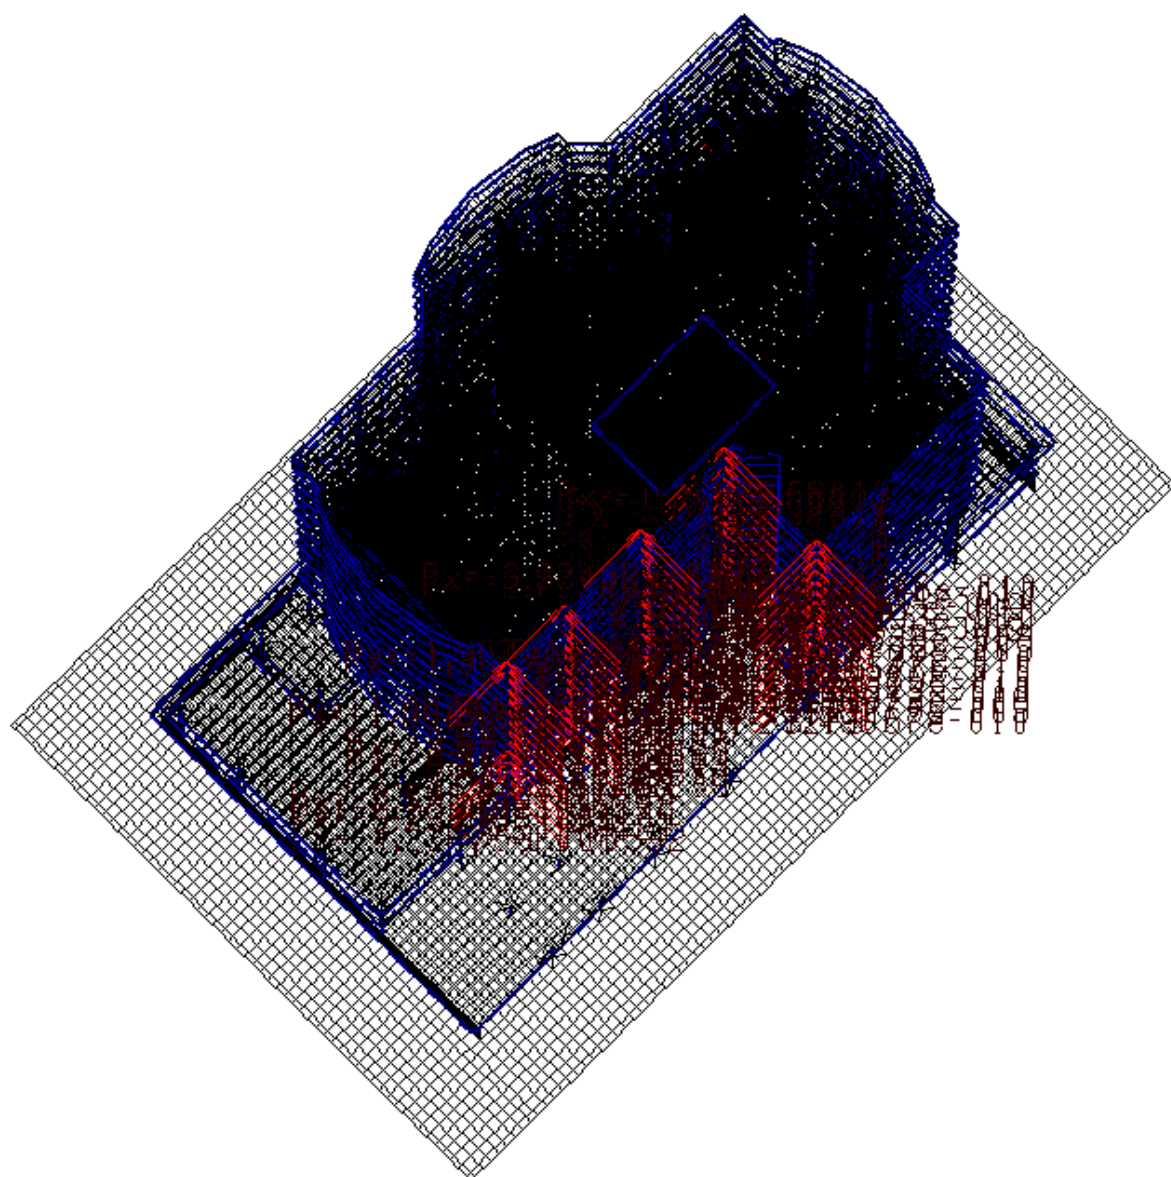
Узловая ветровая нагрузка – ветровой «карман 1» (нагружение 8)
